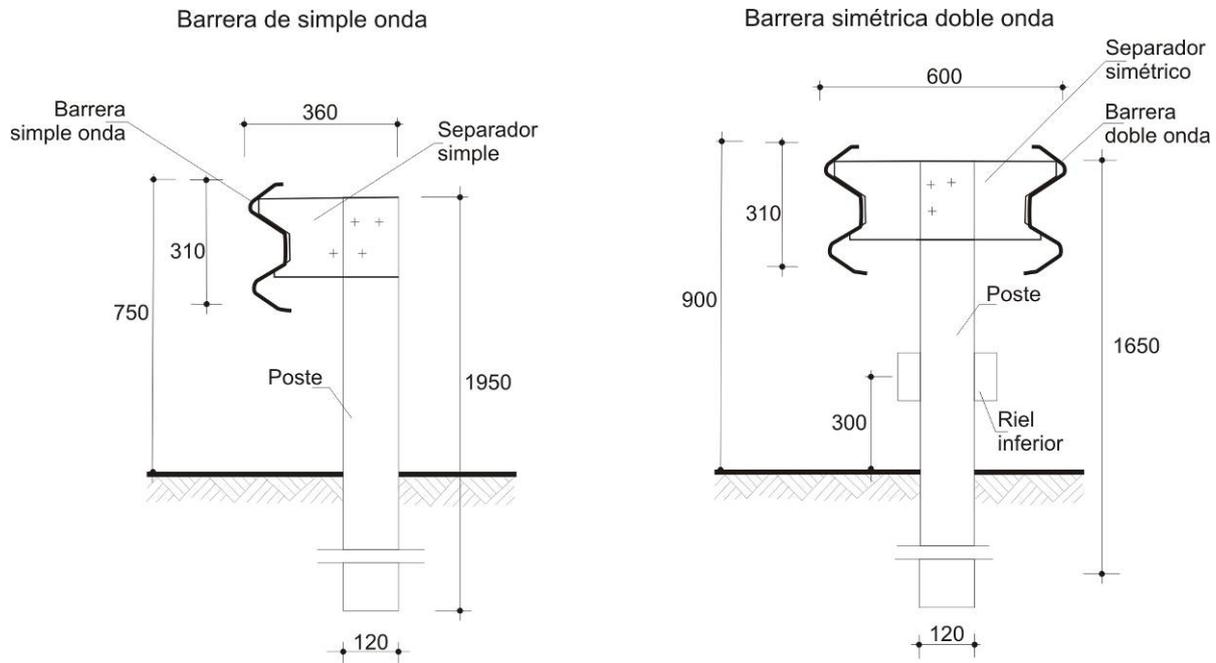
Barreras de metálicas con viga tipo perfil W
